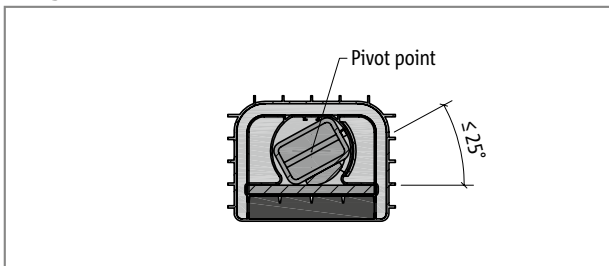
Schöck Tronsole® type Q: Installation variant inclined installation of the load-bearing element
